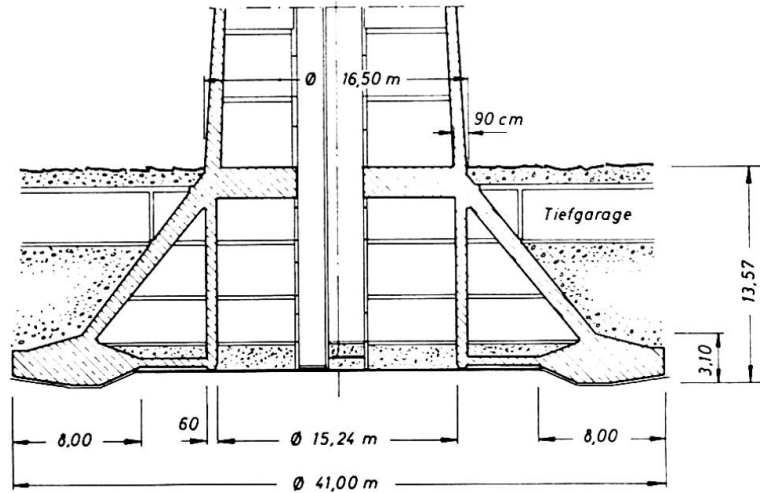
Fundament des Fernmeldeturmes Hamburg mit Kegelstumpfschale und Zylinder
